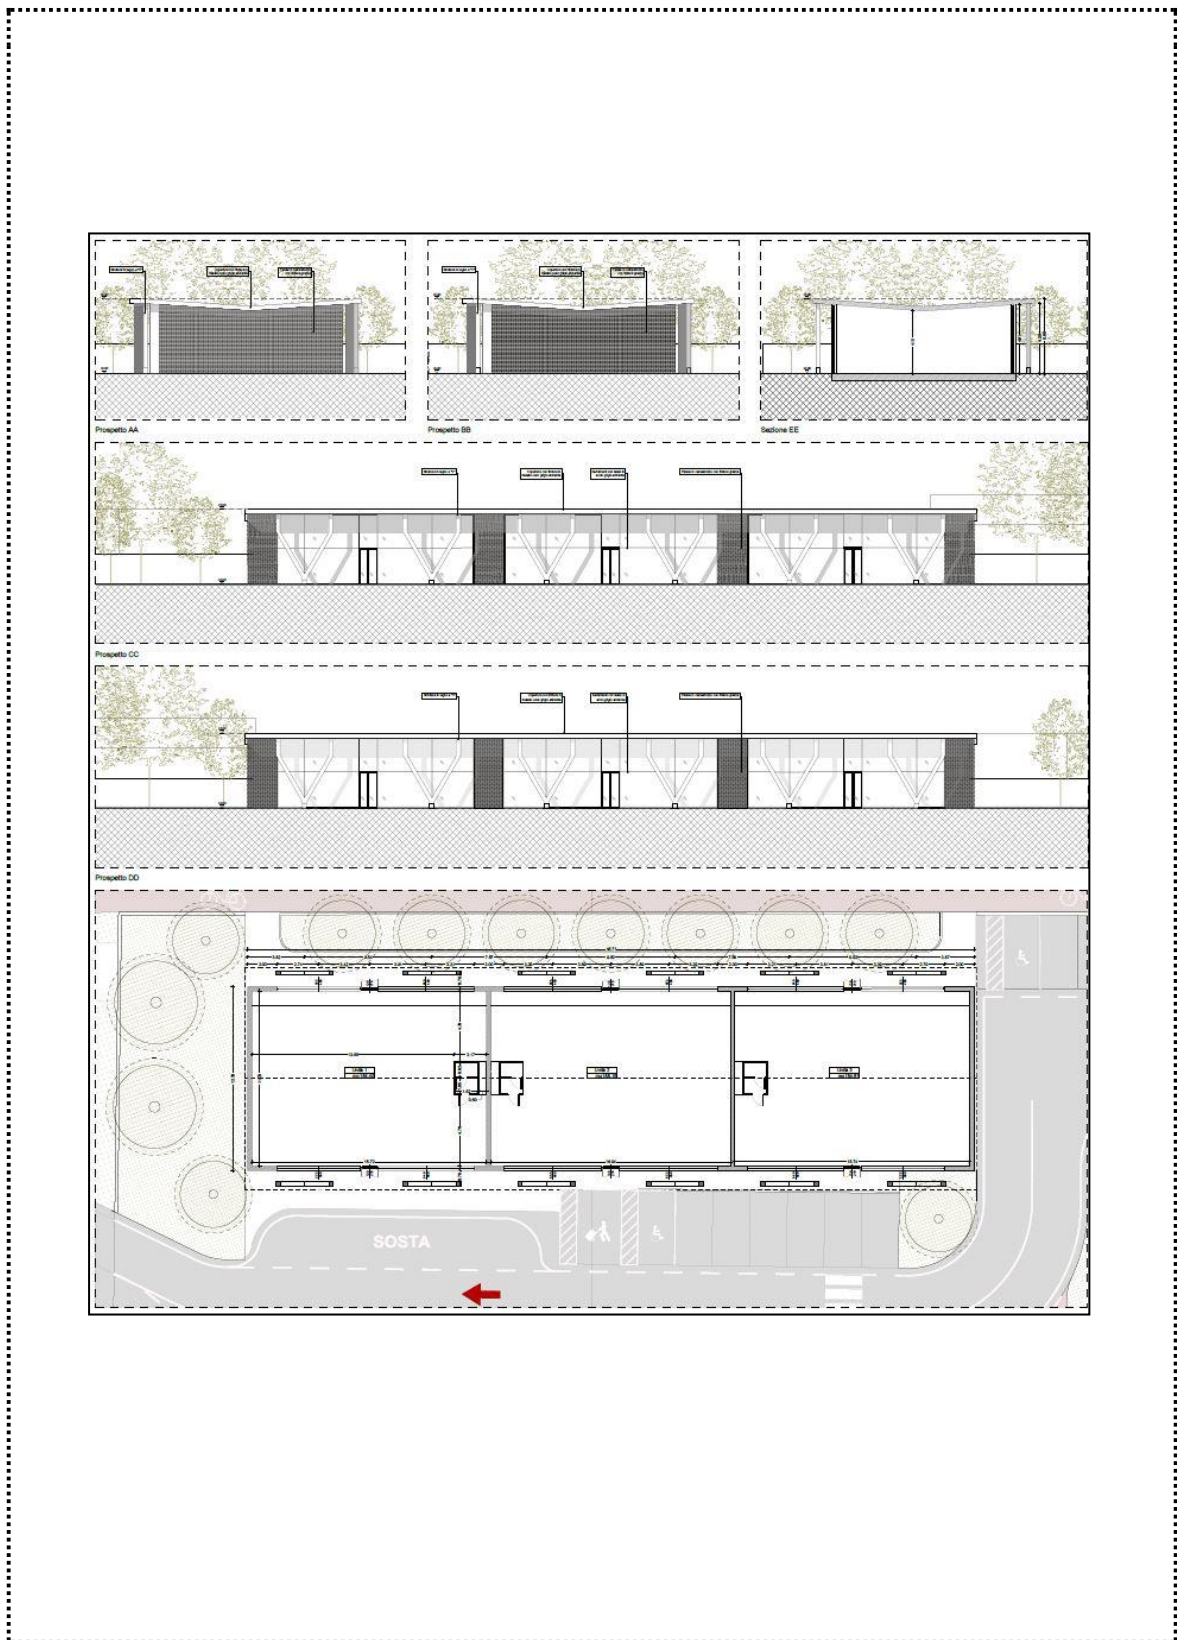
Estratti tavole di progetto – edificio commerciale (T.13)
